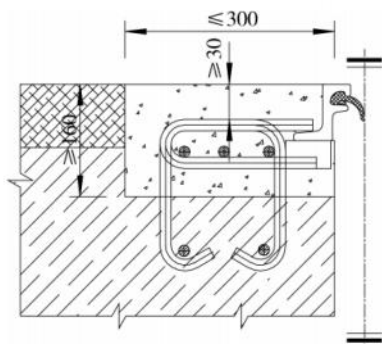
单缝伸缩装置槽口断面示意图(单位:mm)
